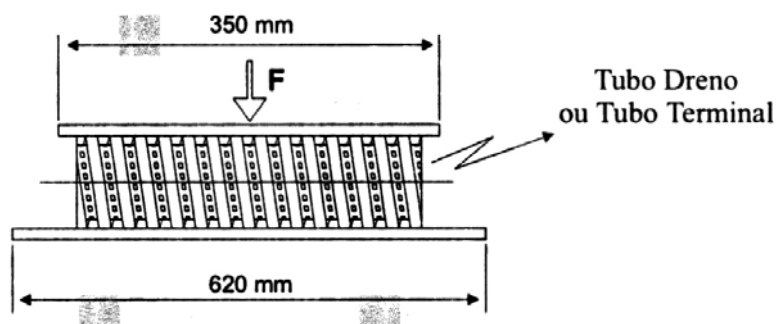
Ensaio de Compressão Diametral do Tubo Dreno.
